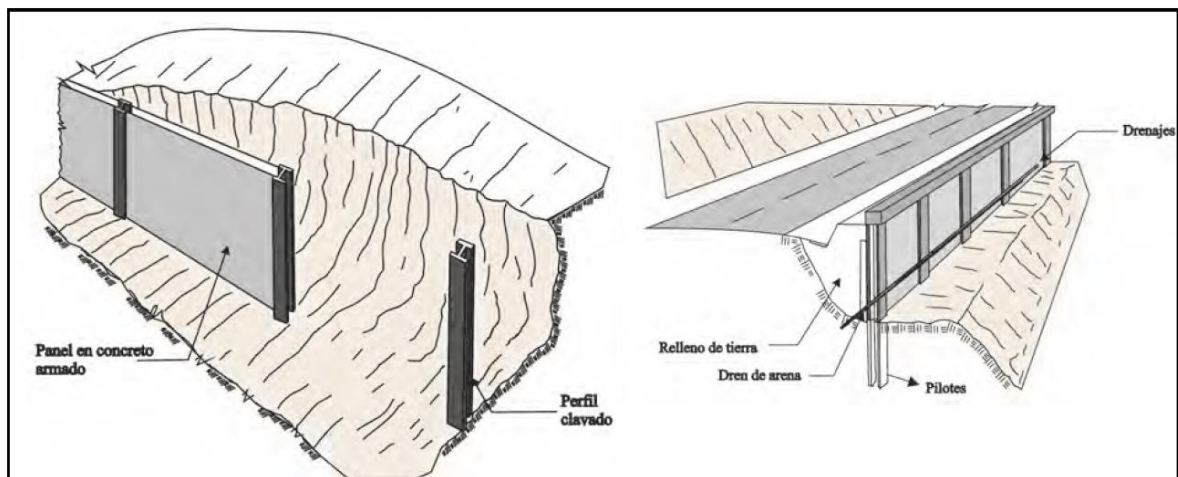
Ejemplo de muros de pantalla y muros con pilotes, (Vilches, 2021)
